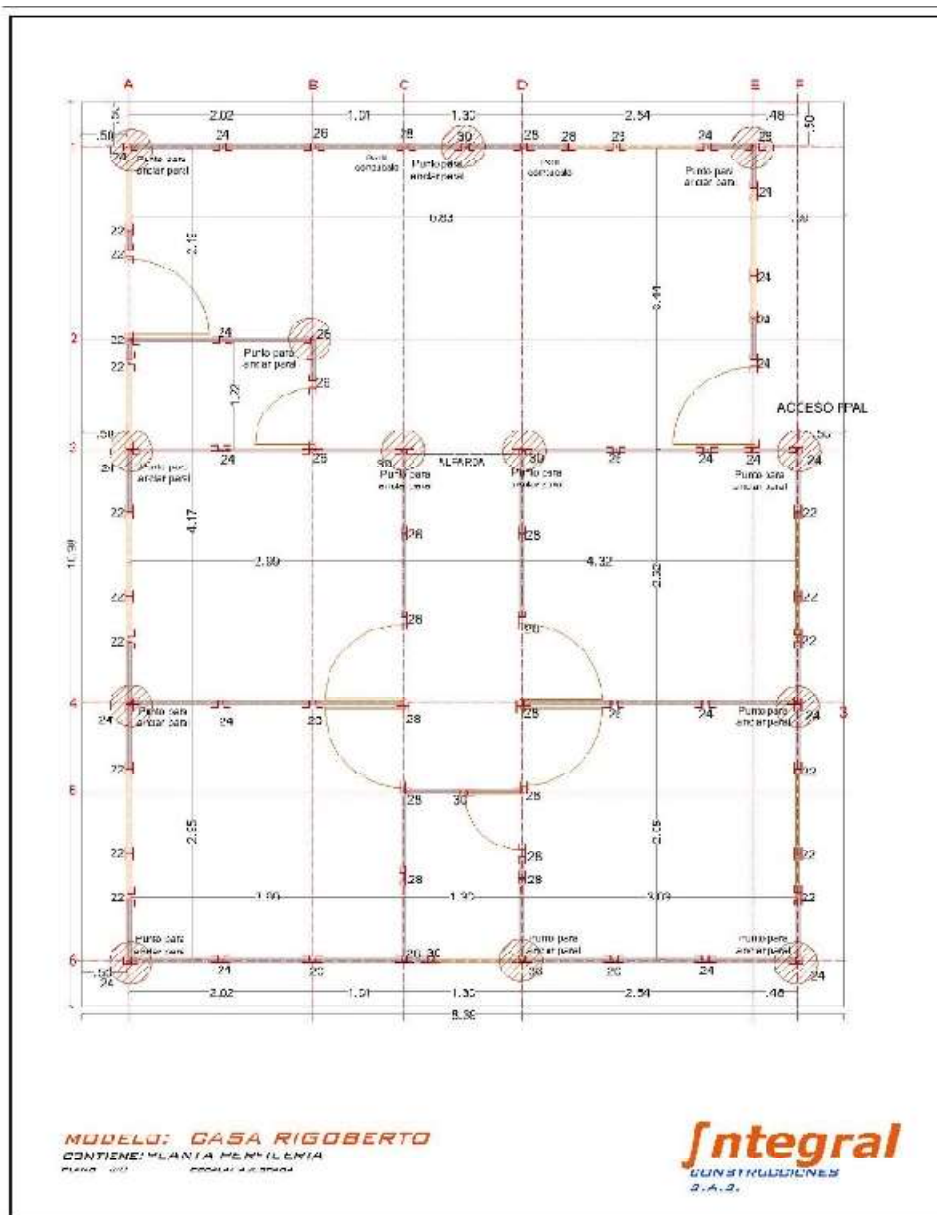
Plano arquitectónico vivienda Rigoberto Ome
